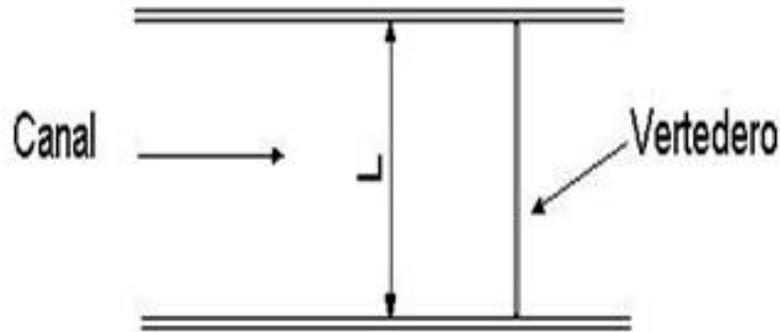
Vista de planta de un vertedero rectangular sin contracciones.
